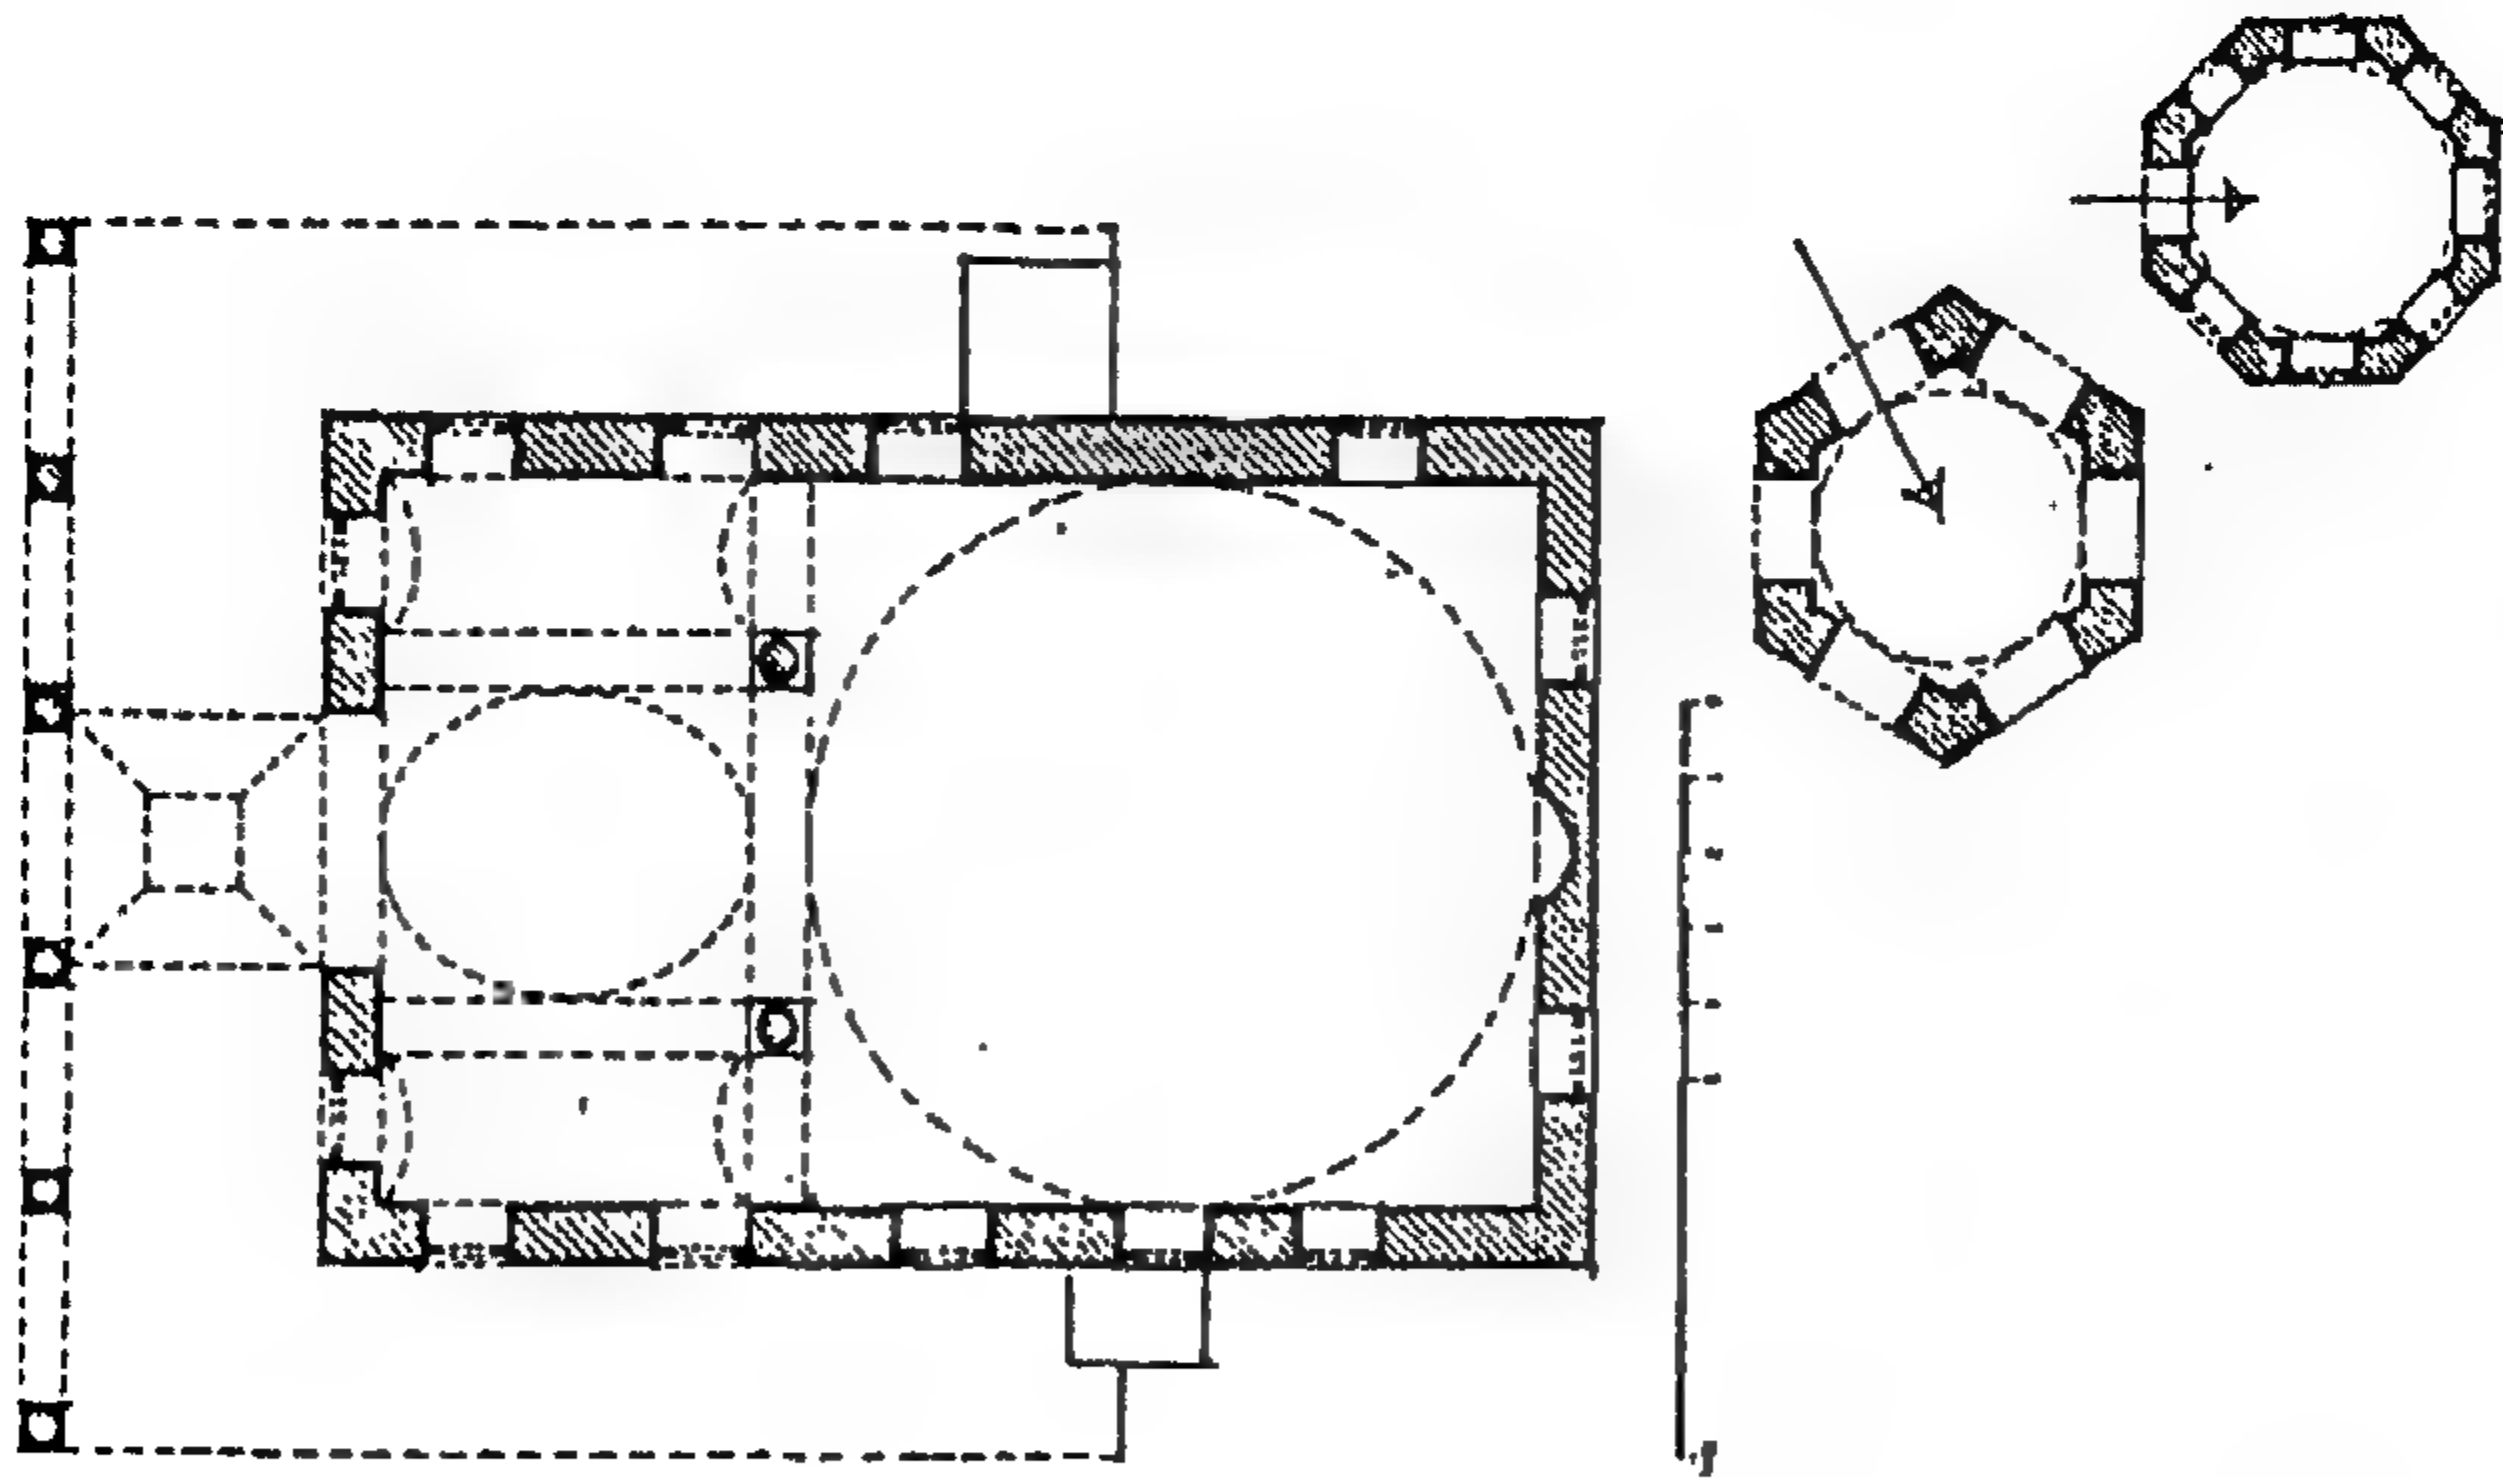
مسقط أفقي لمسجد حاجي شهاب الدين باشا في ادرنه . (عن : Kuran) .
